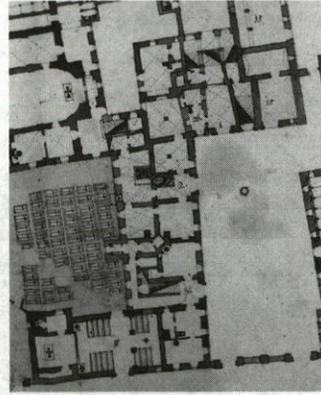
Obermünsterplatz 7, Grundriss vor 1766 und Umbaumaßnahmen 1784-99 (Münchner Plan).
